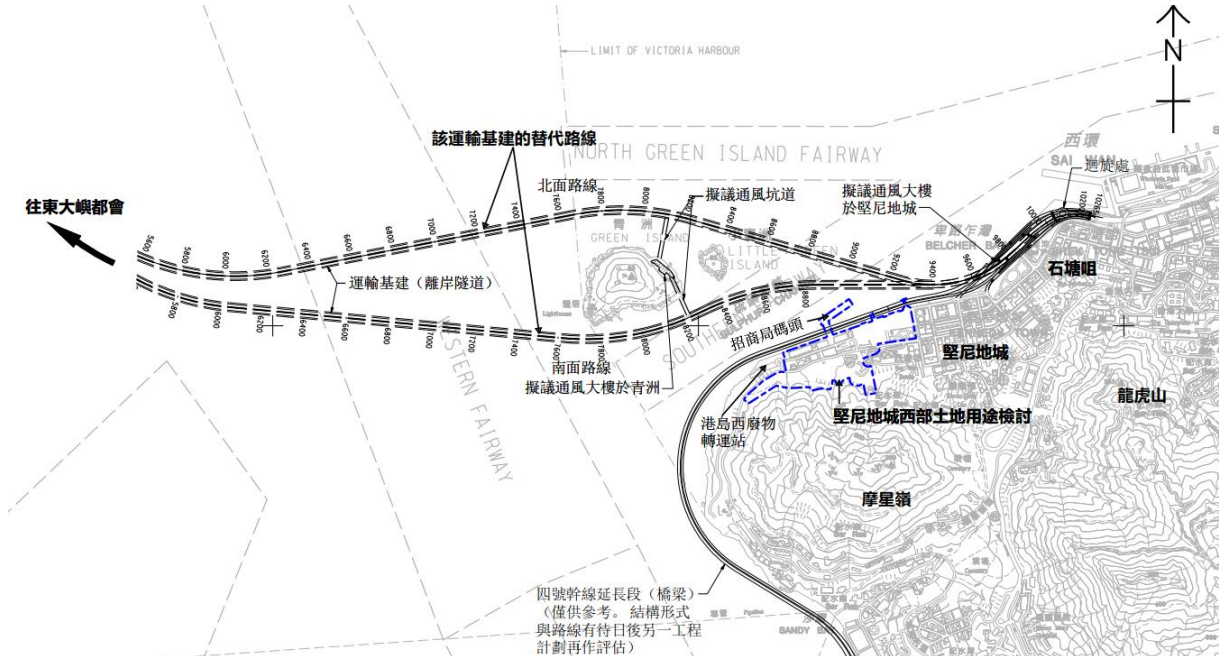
可行方案 H2-1A - 總體佈局平面圖
